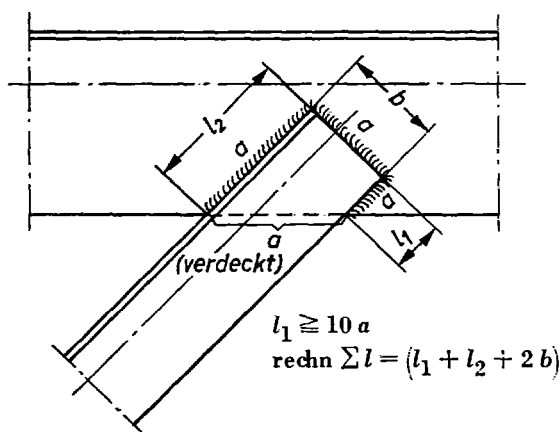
Anschluß mit ringsumlaufender Kehlnaht
